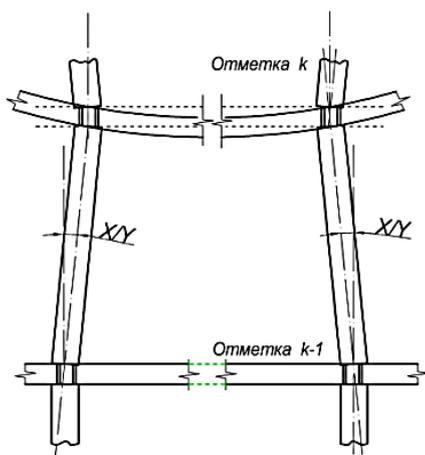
Схемы деформации диска перекрытия и колонн несущего каркаса здания
